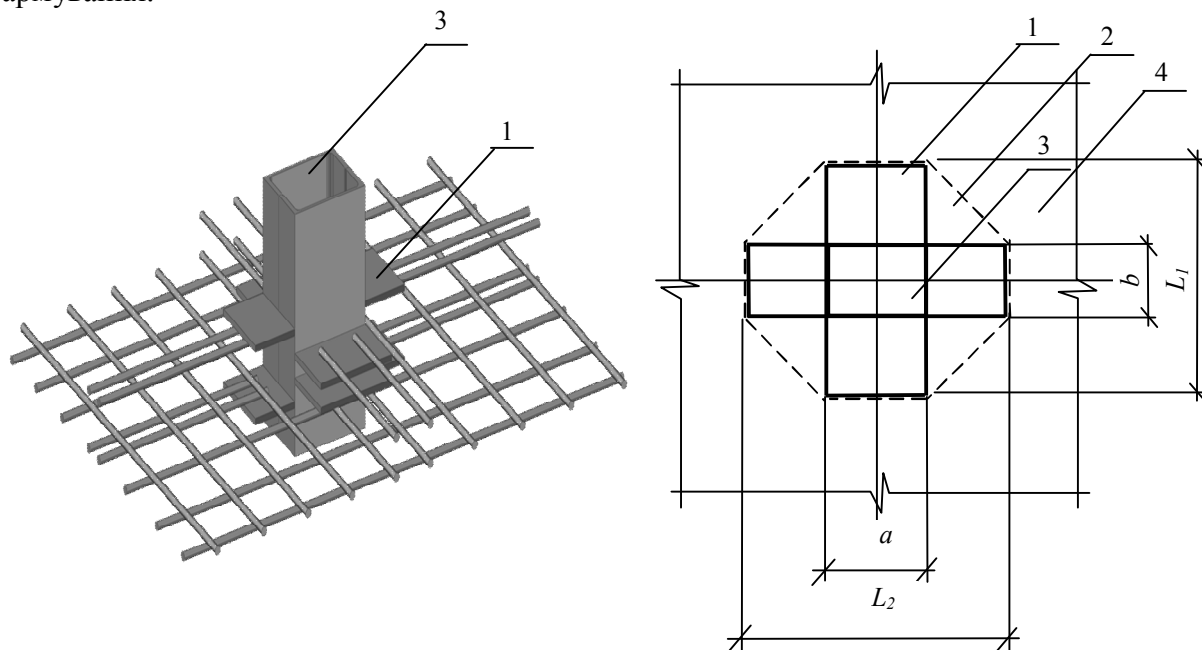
Конструкція вузла з'єднання монолітного перекриття зі сталезалізобетонними колонами та схема для розрахунку фасонки:
